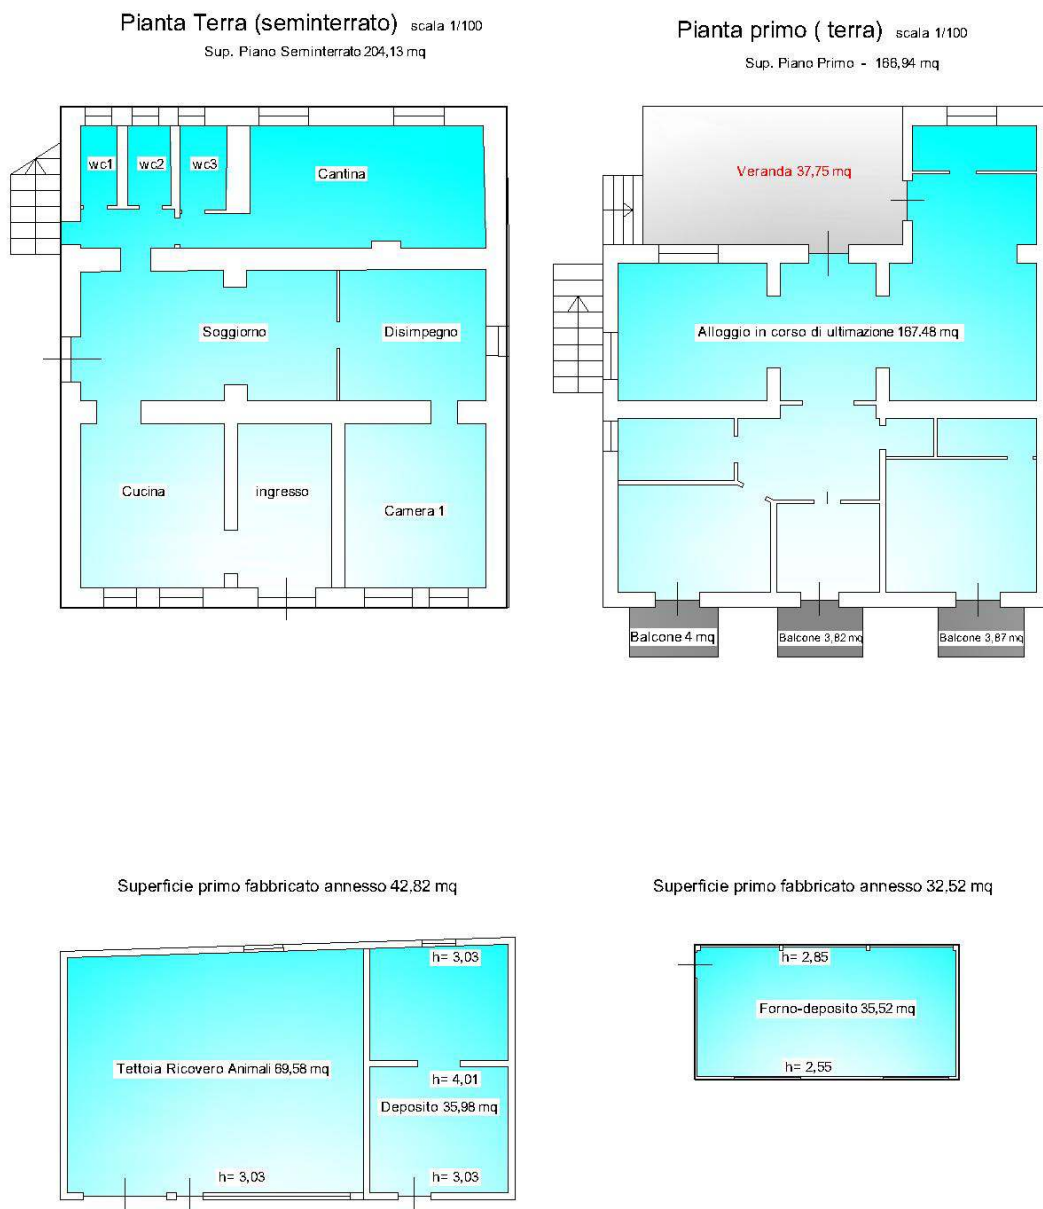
Planimetrie Lotto 3 –Fabbricato Contrada Grappidaro –fg 16 part 988 - Siderno (RC)
